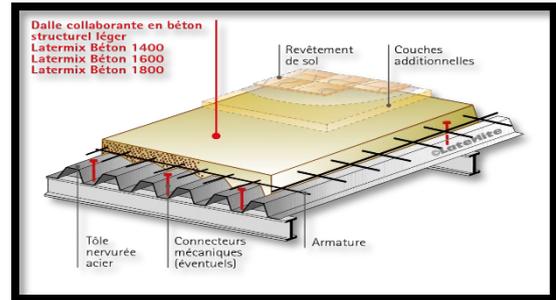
coupe schématique de plancher collaborant (source : latérite)
